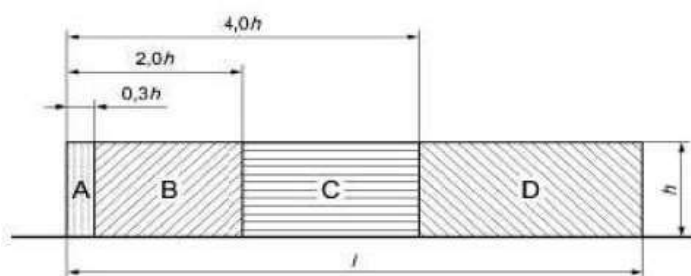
Distribución de zonas de zonas de presión. Fuente: proyecto.
